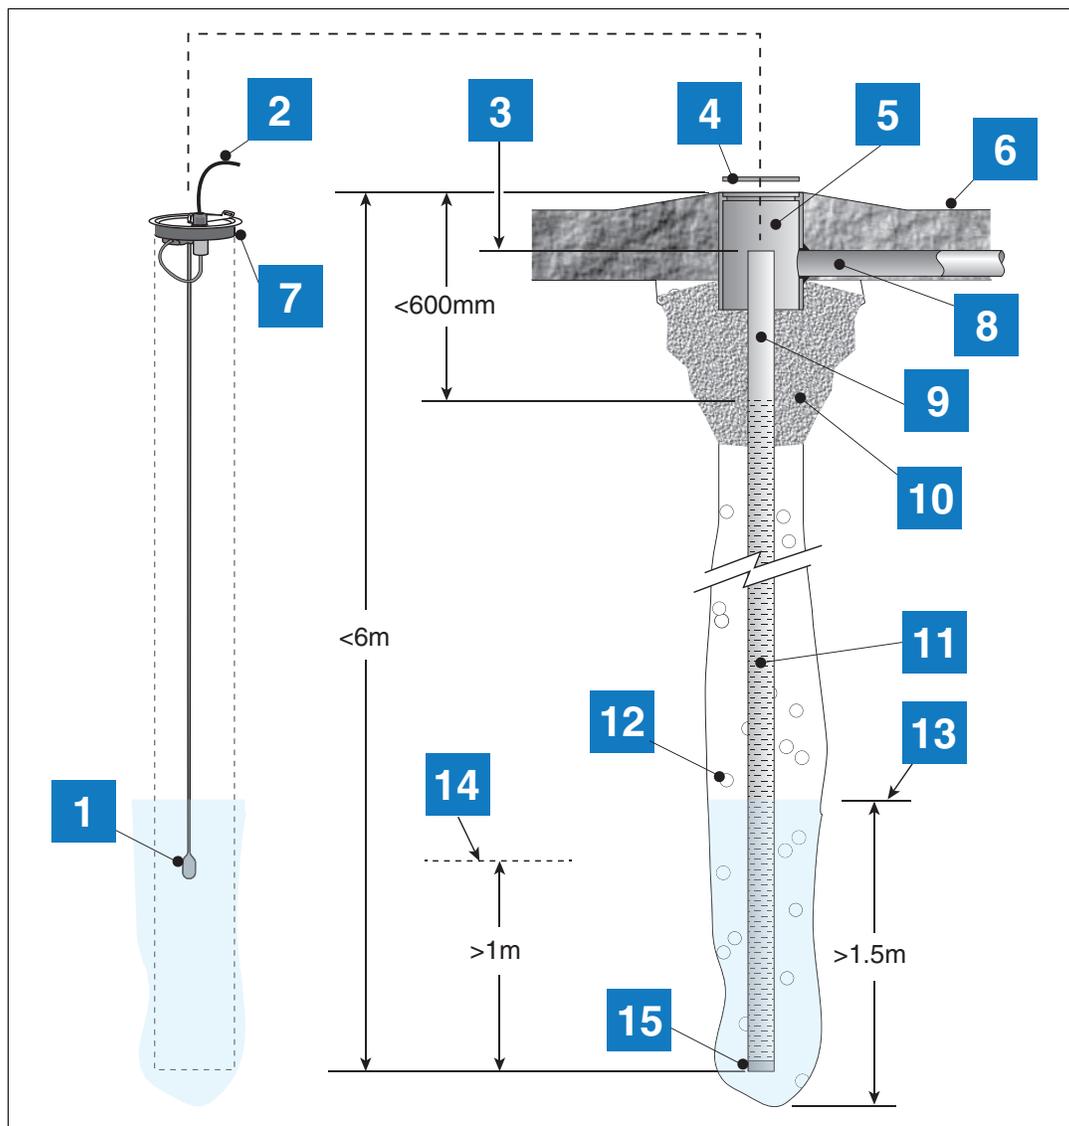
Vista de um Exemplo de Instalação de Sensor de Lençol Freático
